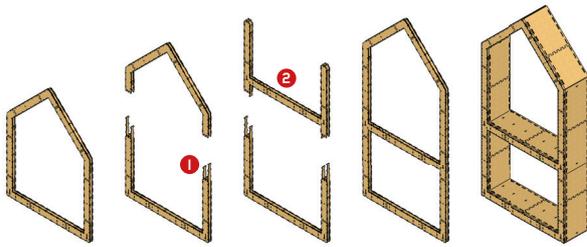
Especificação máxima de expansão vertical do sistema Wren. Fonte: WikiHouse Foundation
